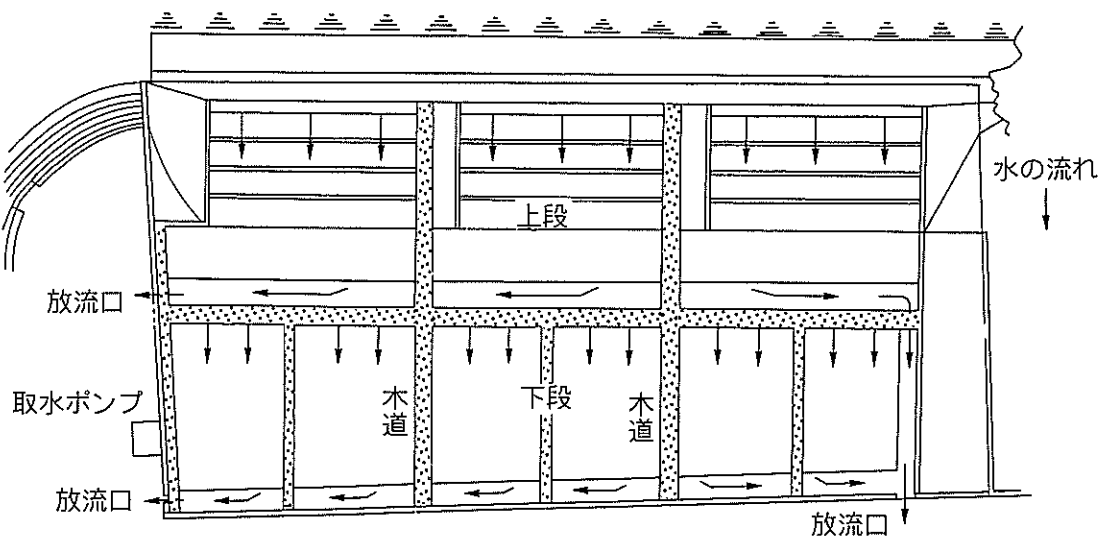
T施設の平面図ならびに給排水配置図<sup>2)</sup>
